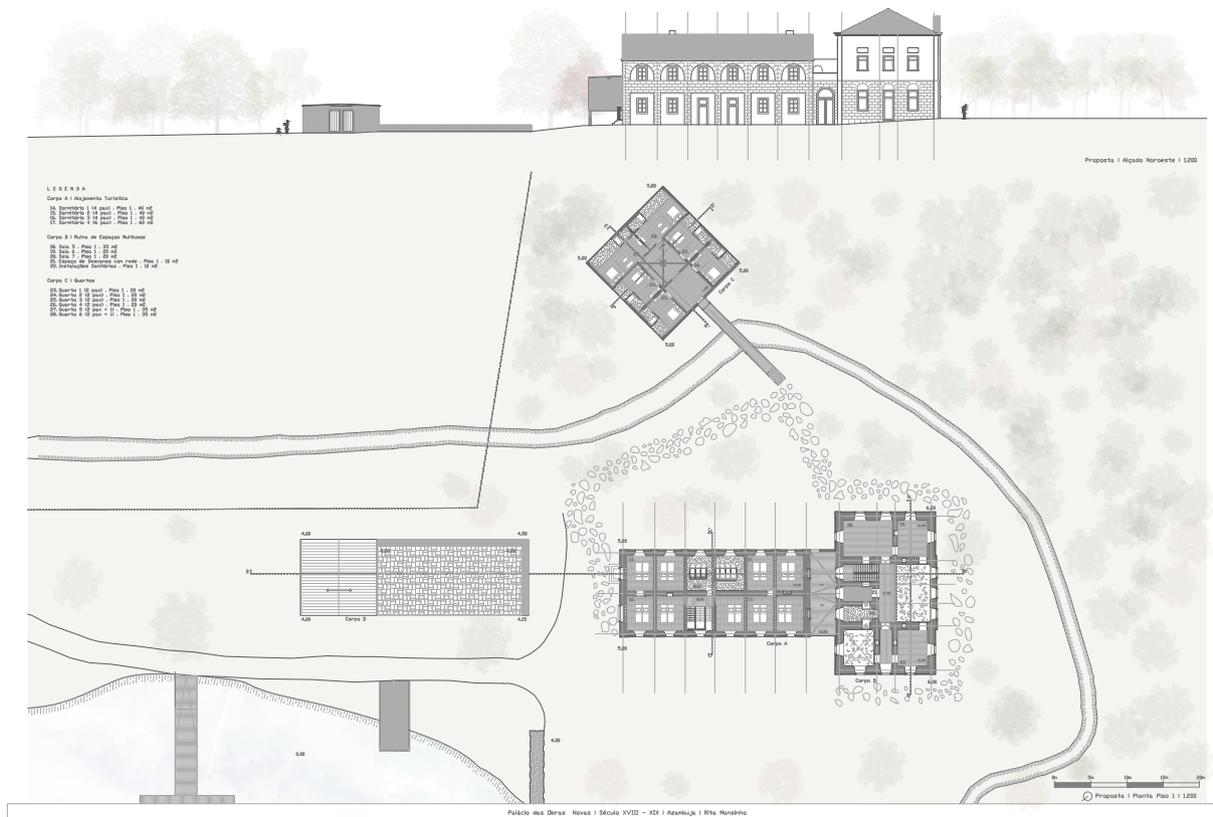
Planta Piso 1 e Alçado (fonte: autora).
